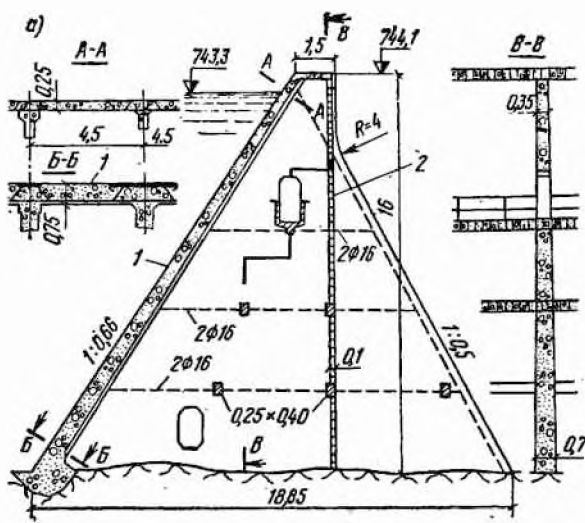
Плотины с плоскими напорными перекрытиями
